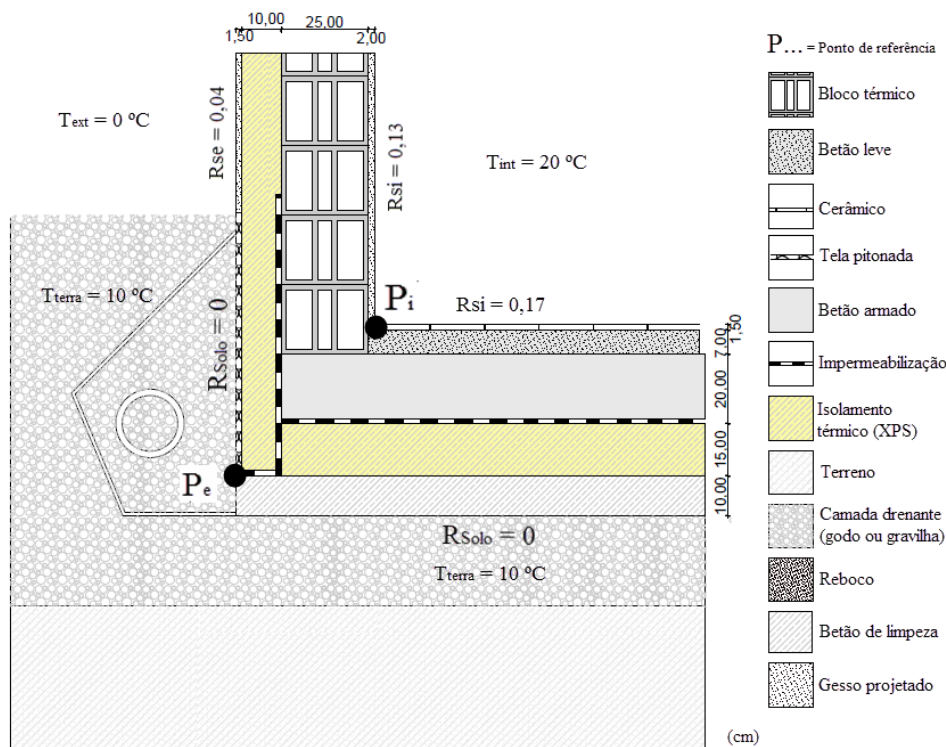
Ligação de fachada (parede simples) com pavimentos térreos (ensoleiramento)
